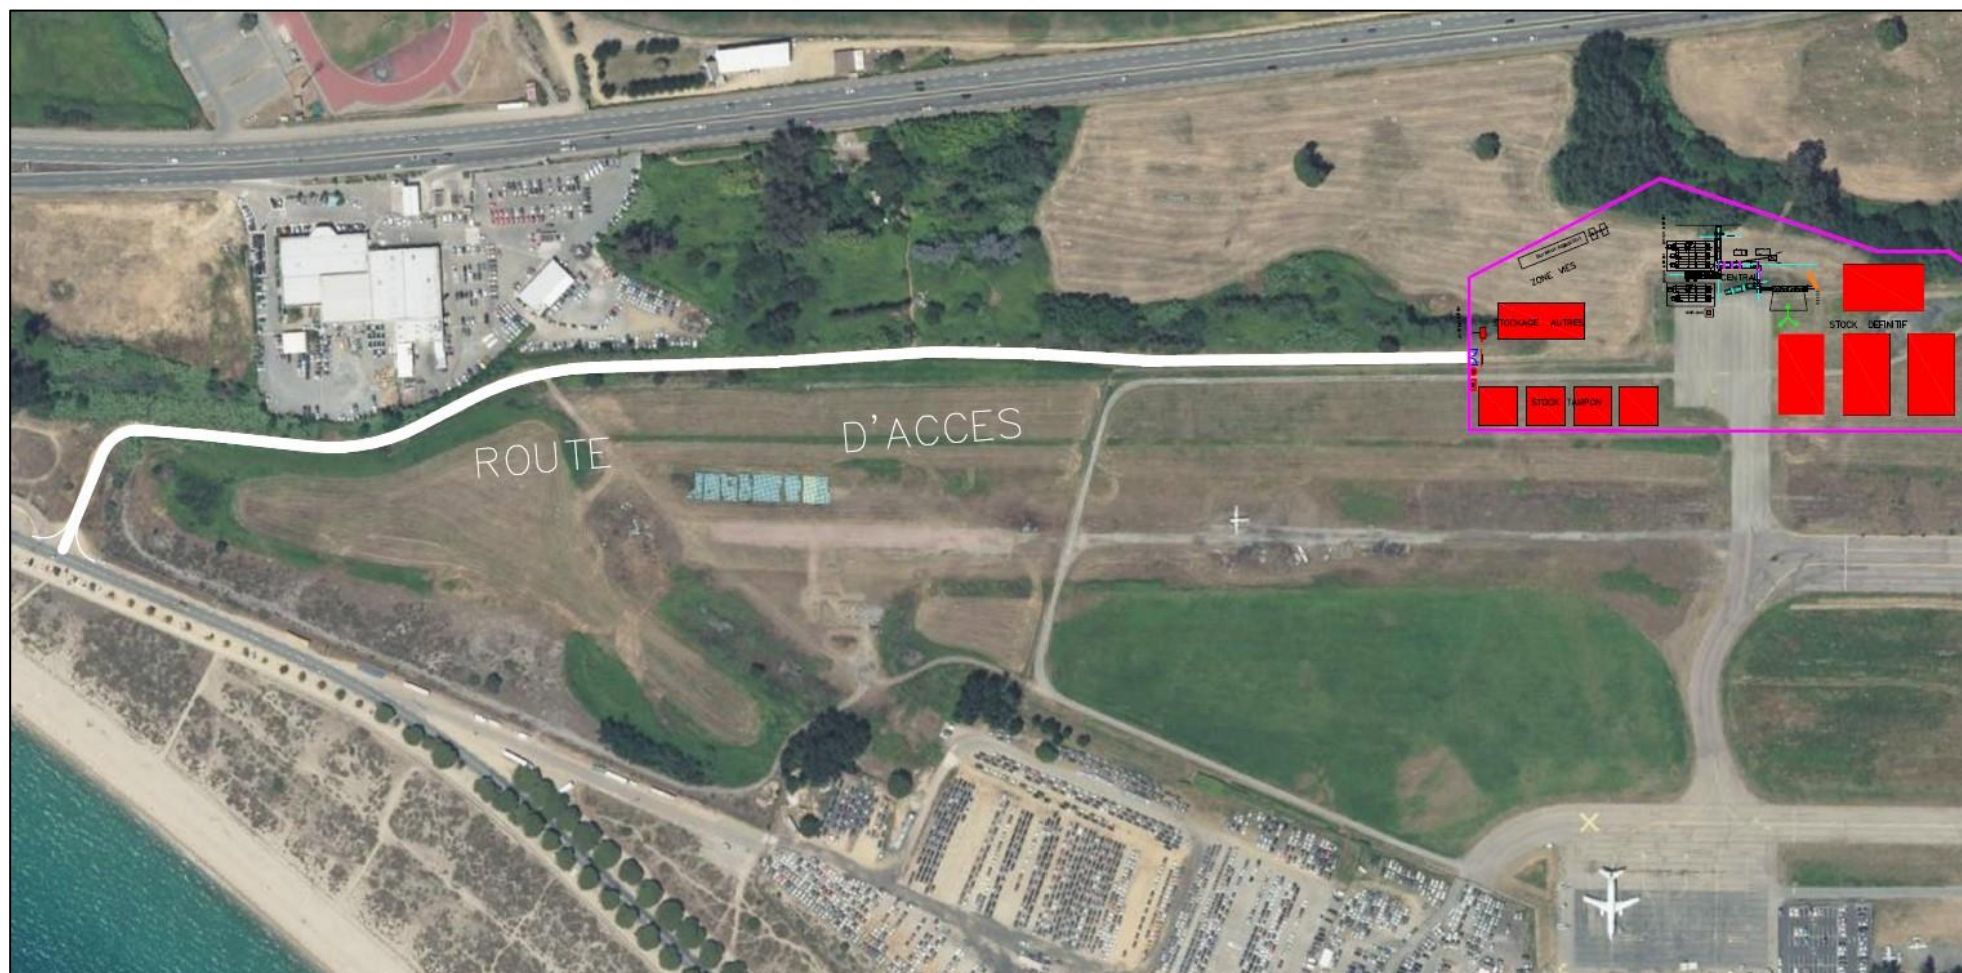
Plan de l'accès au chantier (Source : Collectivité de Corse)
